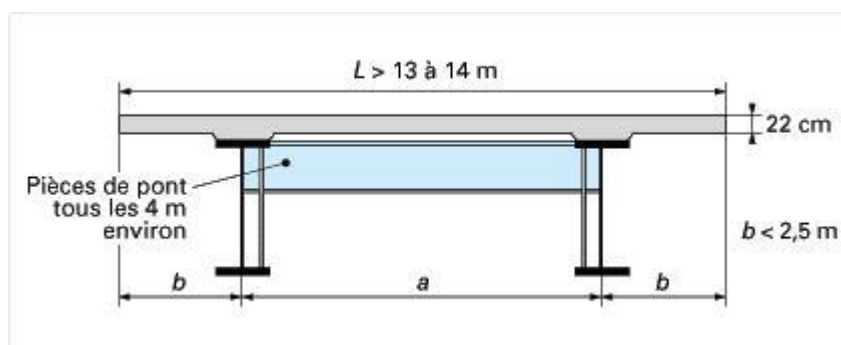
Tablier bipoutre à pièces de pont [2]
